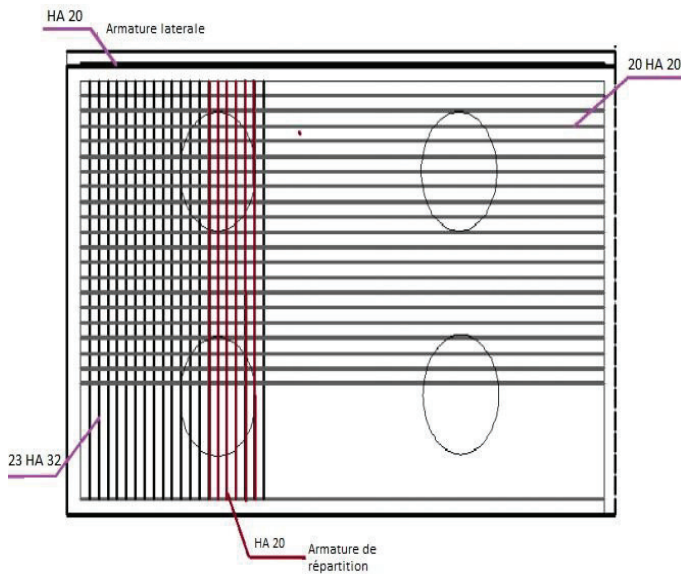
ferrailage de la semelle (nappe inférieure)
